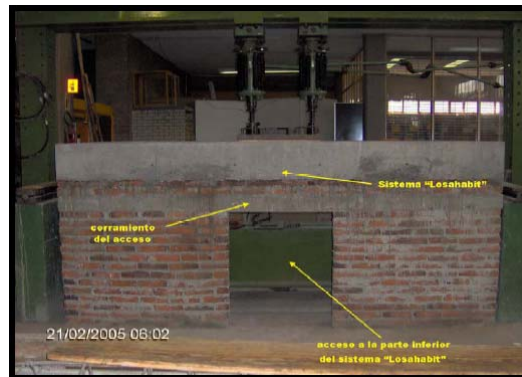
Estructura de mampostería con entrada en la parte inferior del sistema losahabit
